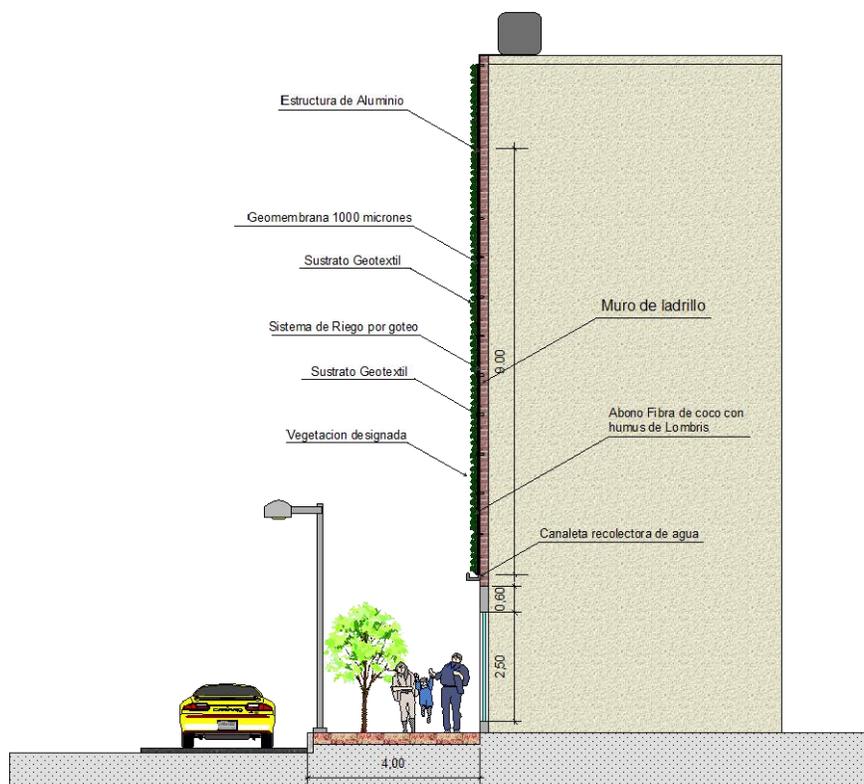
Corte de edificio Lazcano tramo 1 fachada este ESC: 1.100
